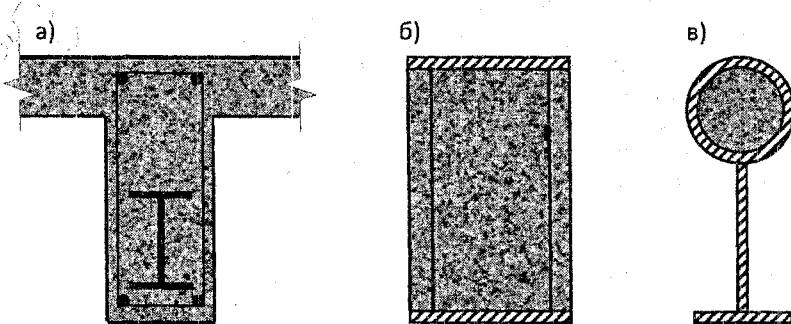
Поперечні перерізи сталезалізобетонних балок і ригелів:
